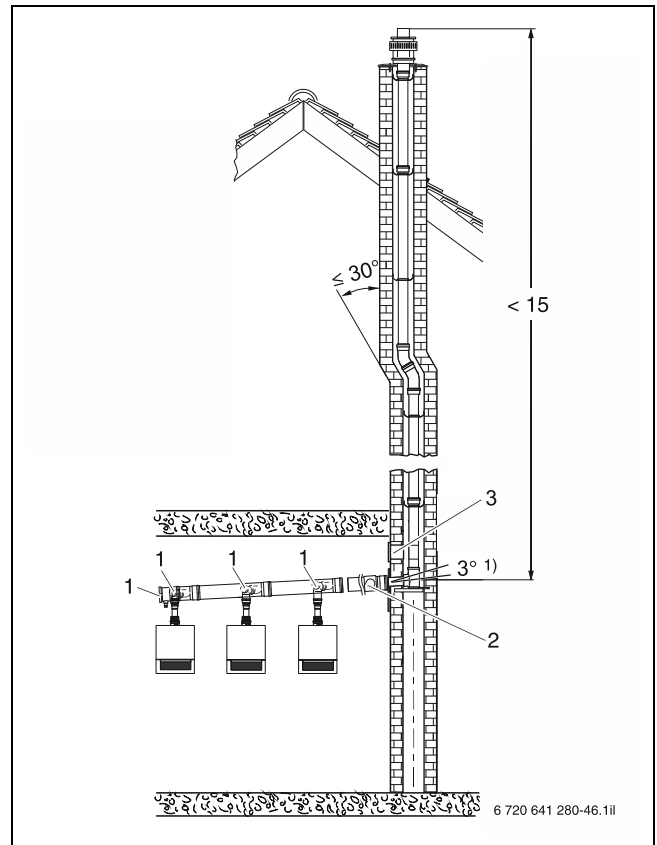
Пример расположения смотрового люка в каскаде (размеры в метрах)
